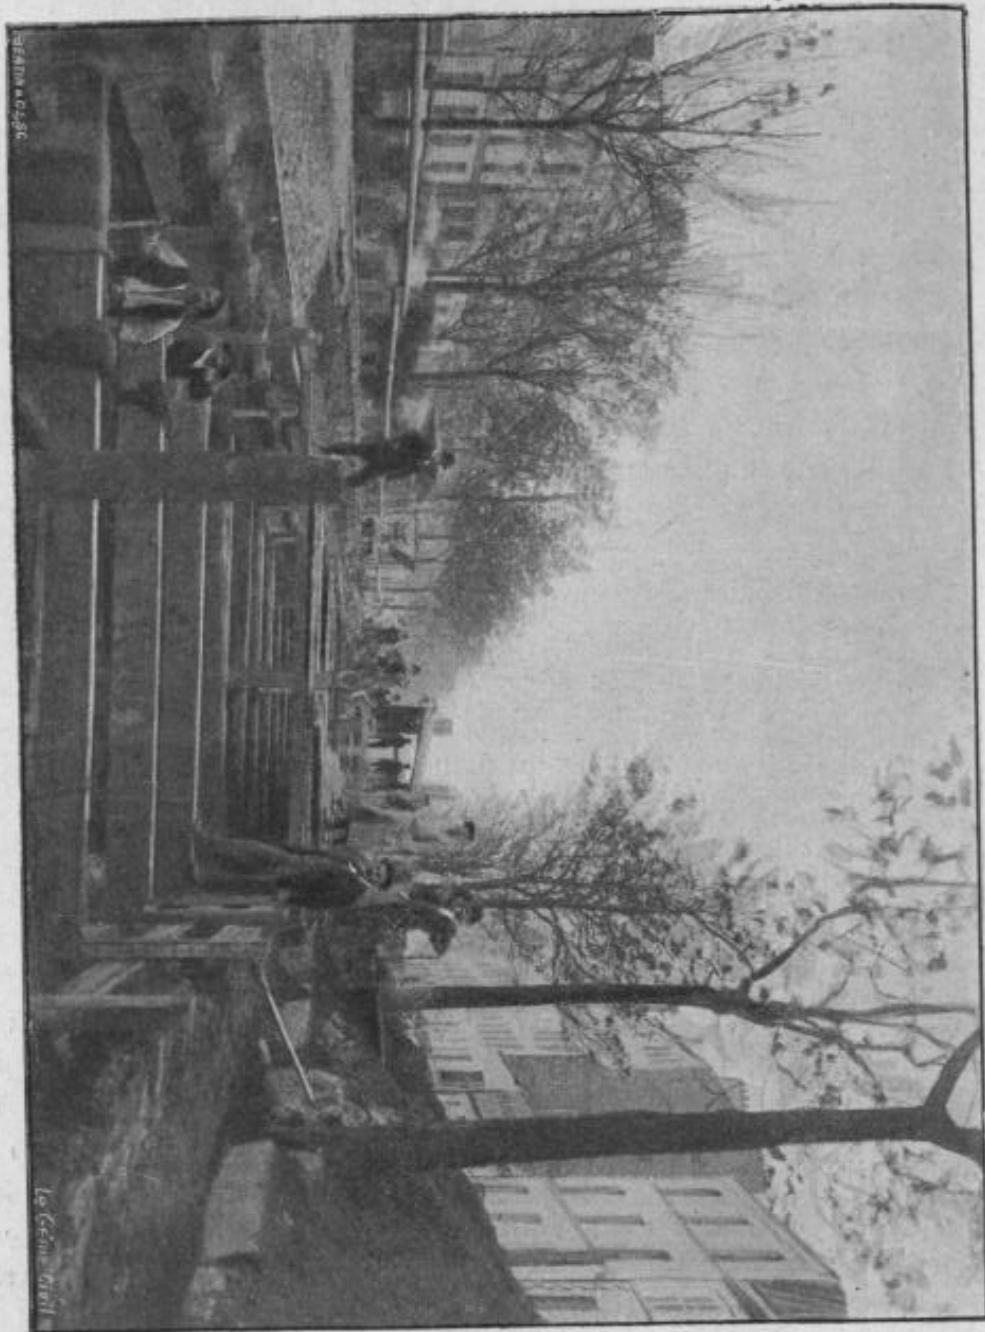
Construction d'un nouvel égout collecteur sous le boulevard de Belleville :
